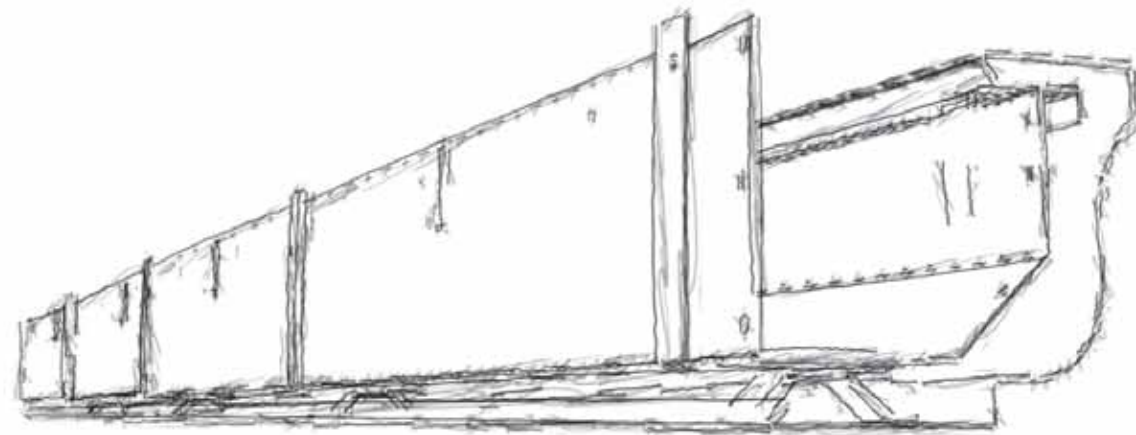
Canaleta de desagüe pluvial para techo. Elaboró: DAJM.
